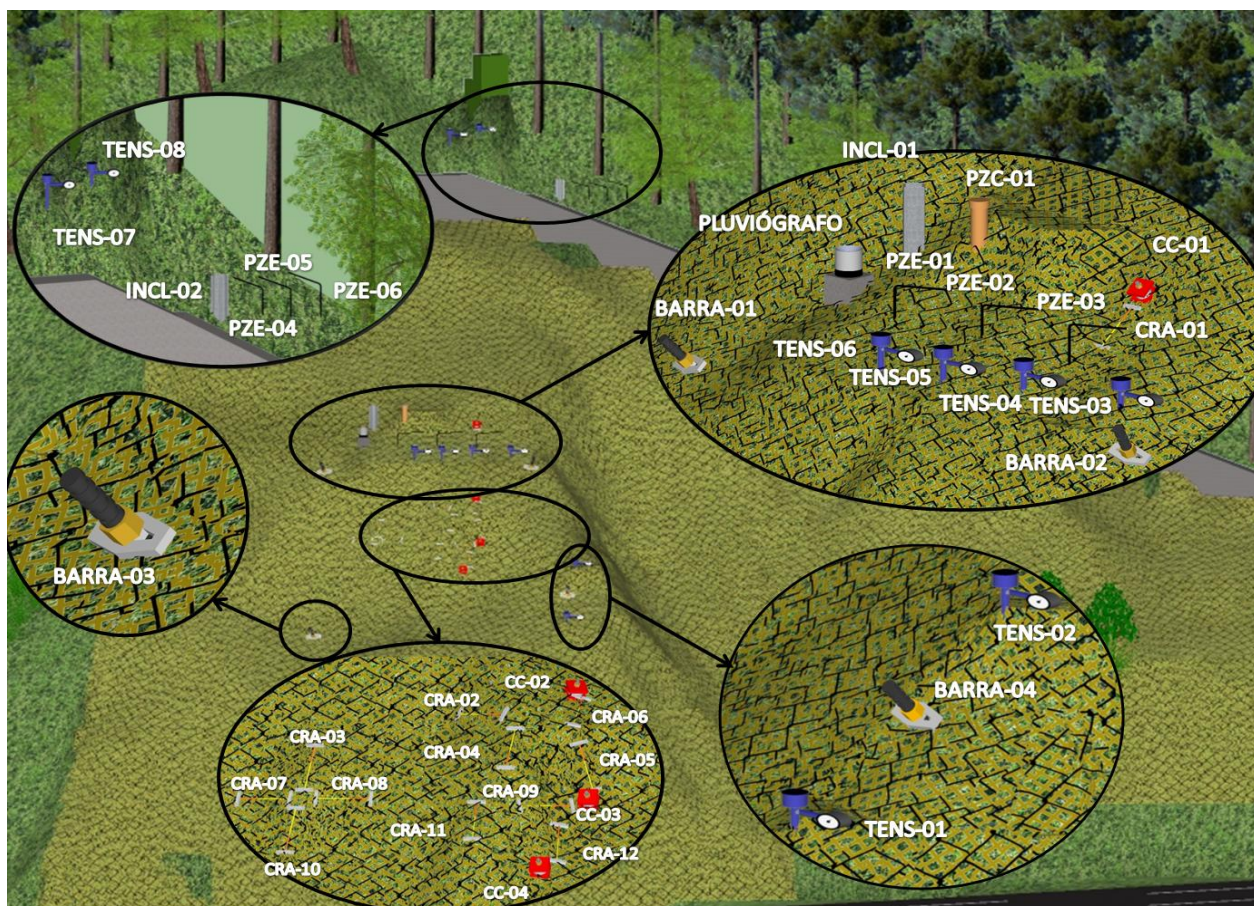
Plano de Instrumentação – Representação tridimensional em detalhe
